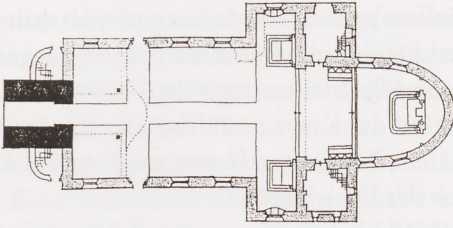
Bergatreute, Pfarr- und Wallfahrtskirche
